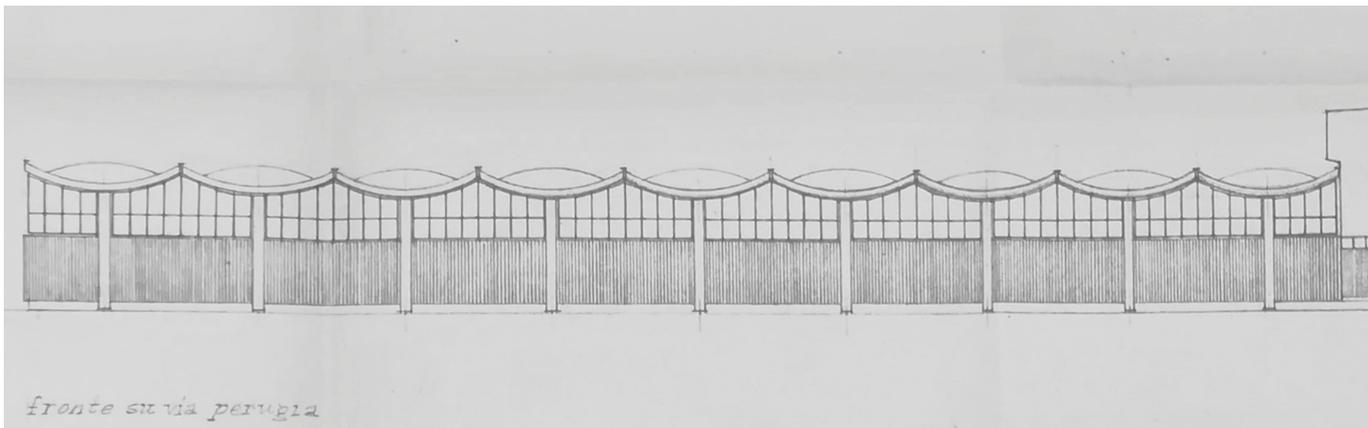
Progetto preliminare per il Mercato dei Fiori, sezione longitudinale, arch. Cesare Bersia , Archivio storico di Torino
